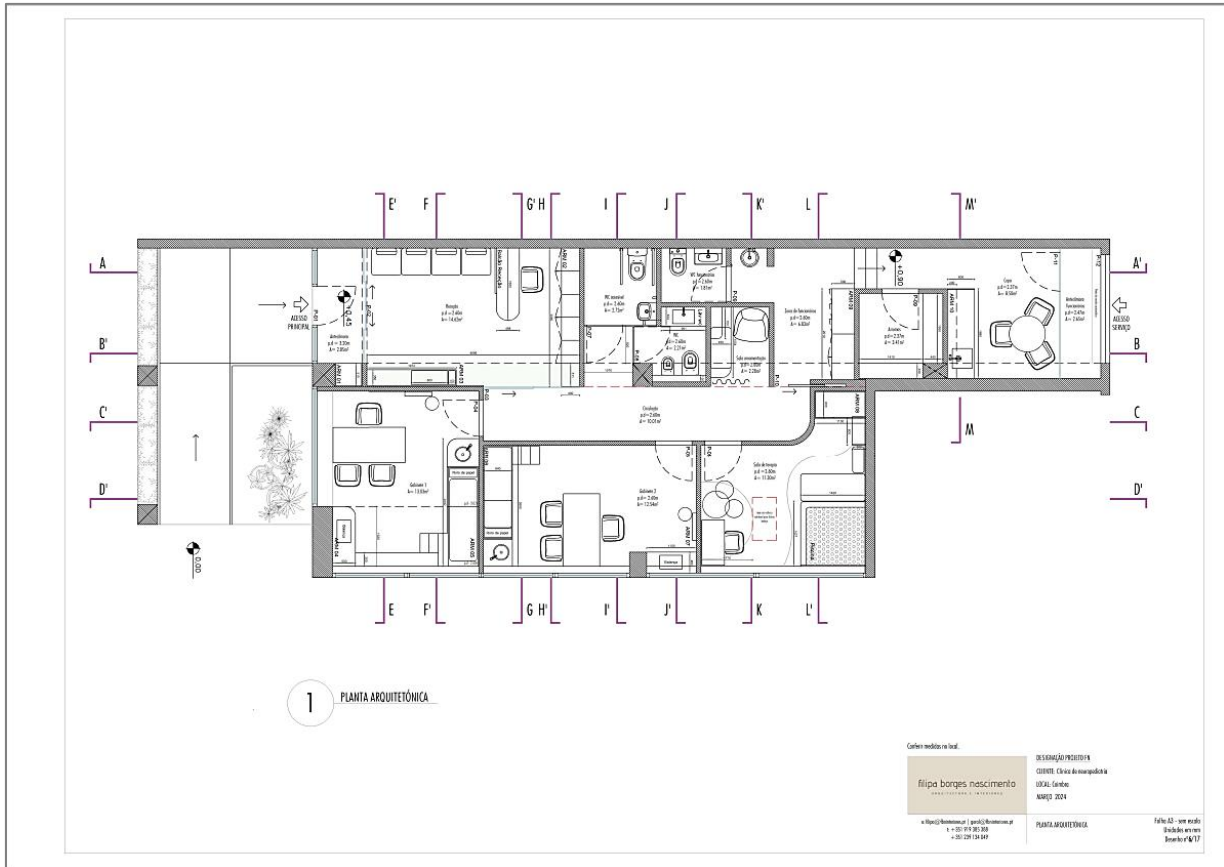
Planta arquitetónica do layout final - Projeto CNP. Fonte: Equipa FBN.
